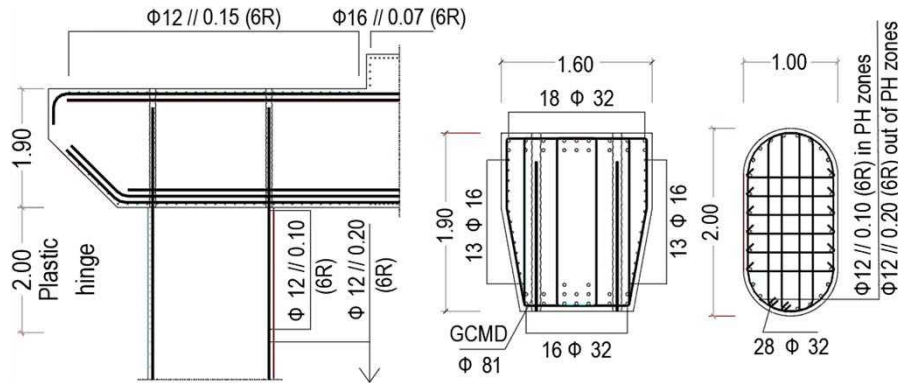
Secção transversal e *layout* de armaduras da coluna e da travessa.
